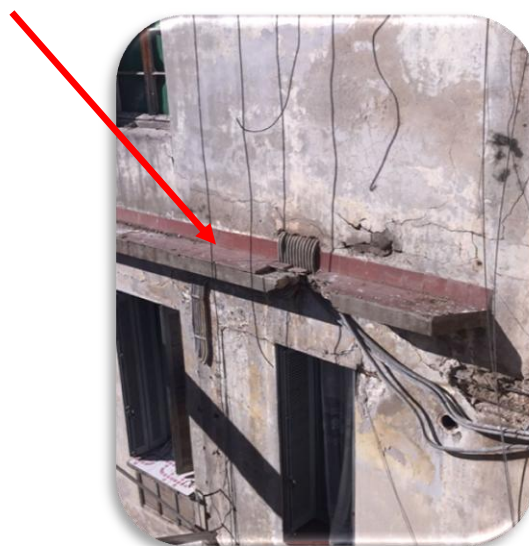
56 Dégradation des enduits et présence des fissures
